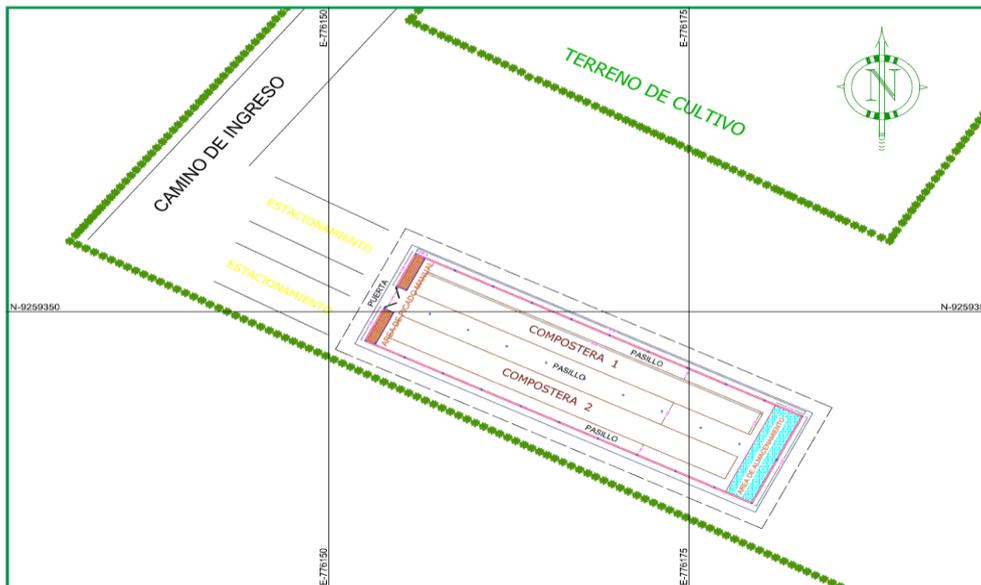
Distribución de las áreas en la zona de la planta de compost.
